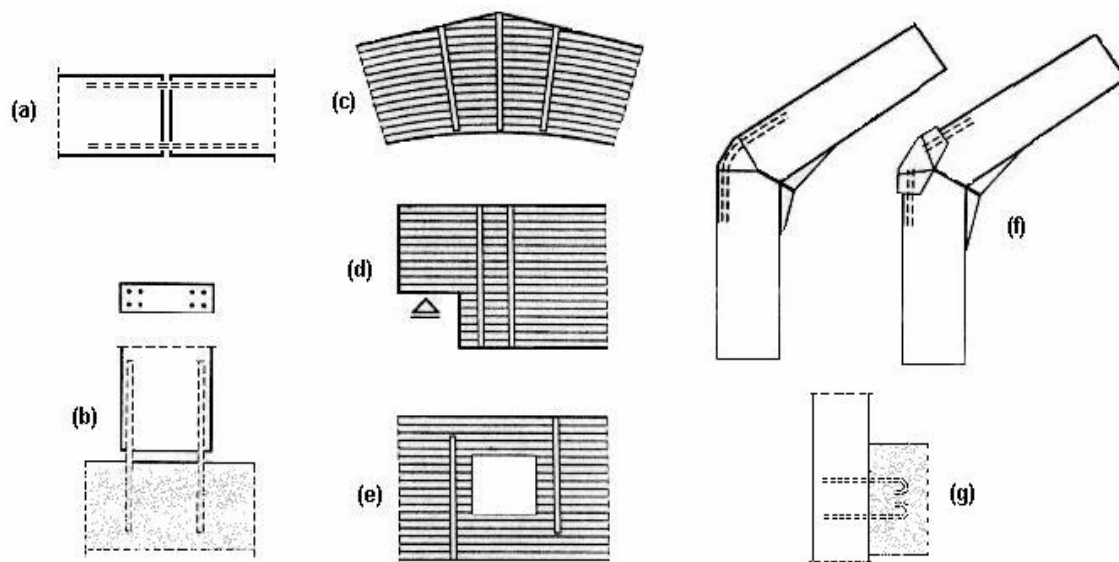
Exemplos de aplicação de barras de aço coladas em estruturas de madeira.
